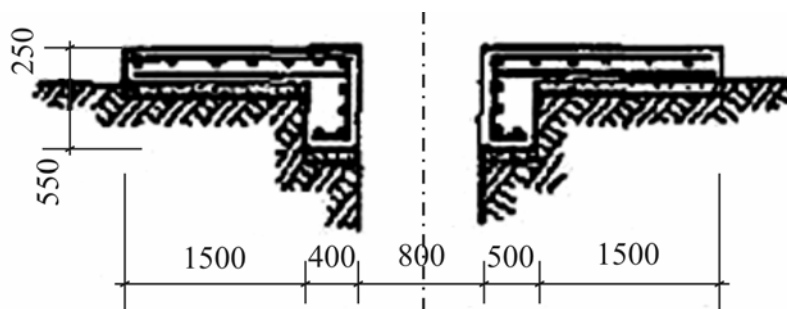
Конструкция форшахты из монолитного железобетона [12]
